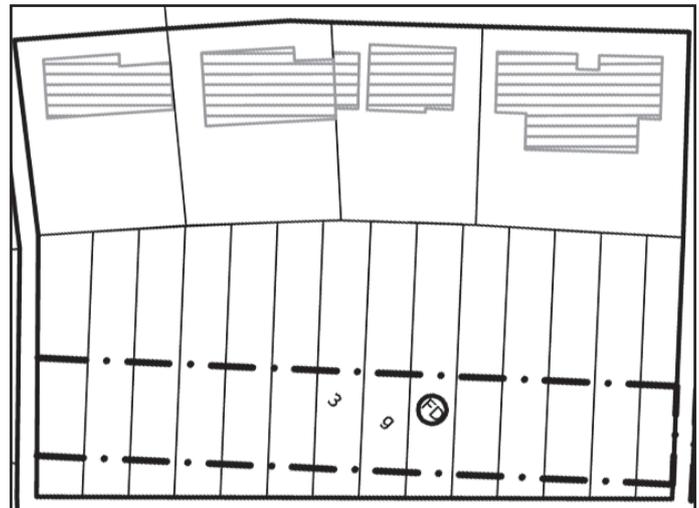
Bestehende Einfamilienhaus- vs. geplante Townhouseparzellen. Ausschnitt aus dem Bebauungskonzept.
